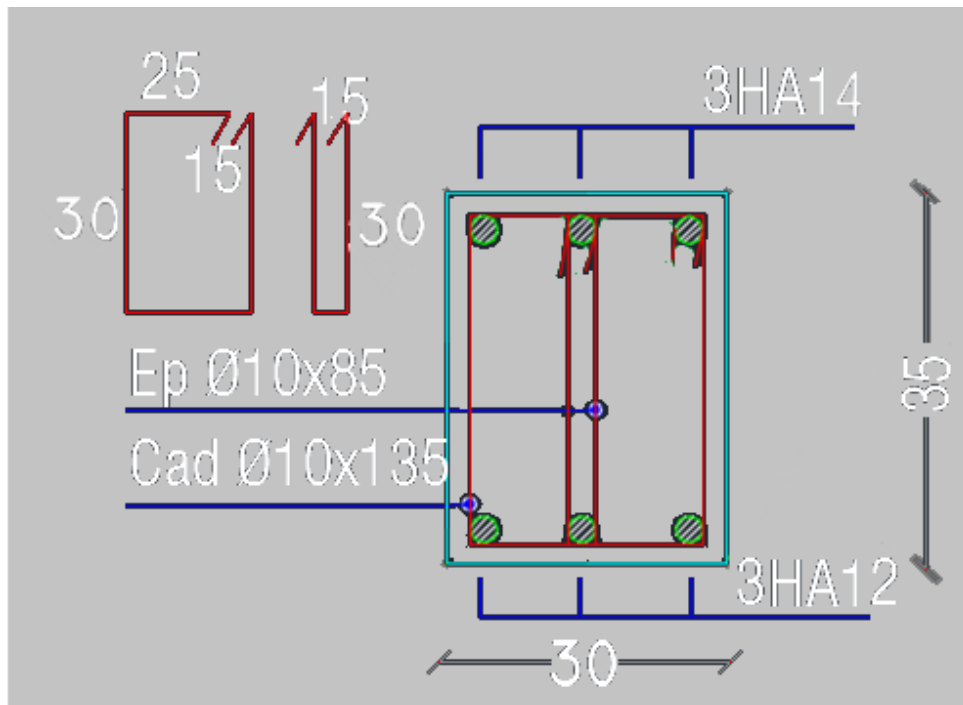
Ferrailage des poutres secondaires en travée de niveaux 1<sup>ème</sup> à 4<sup>ème</sup> étage.
